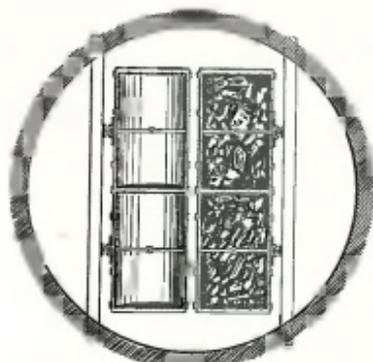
Briartsche Führung mit zwei Einstrichen.
